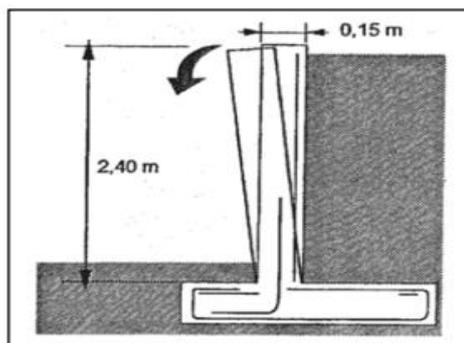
Schéma d'un mauvais emplacement des armatures d'attente.
